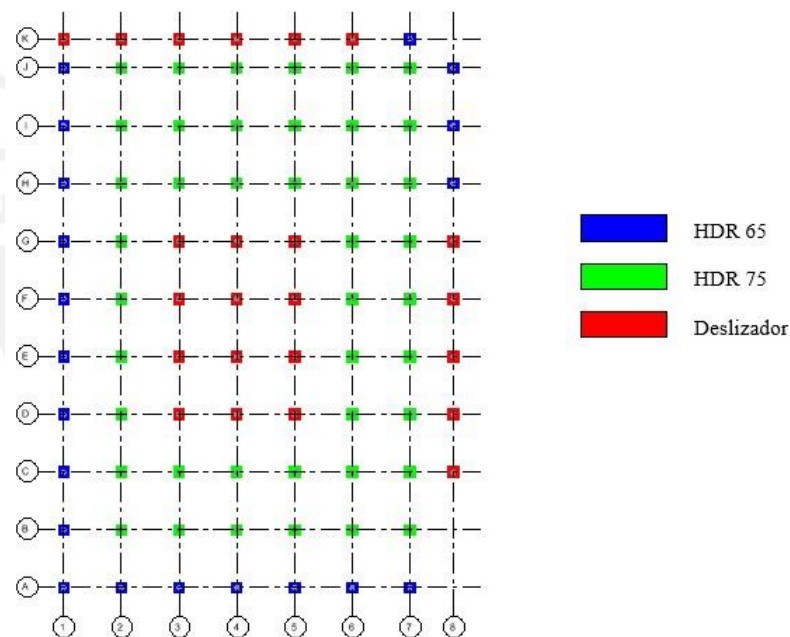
Distribución en planta de los dispositivos de aislamiento.
